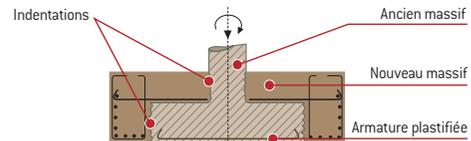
Fondations : renforcement avec surépaisseur de la semelle (coupe transversale)
